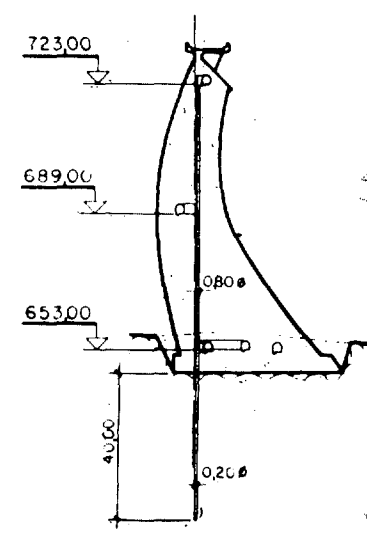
^a — Presa-bóveda. Galerías y red de drenaje. Alzado y secciones tipo.
